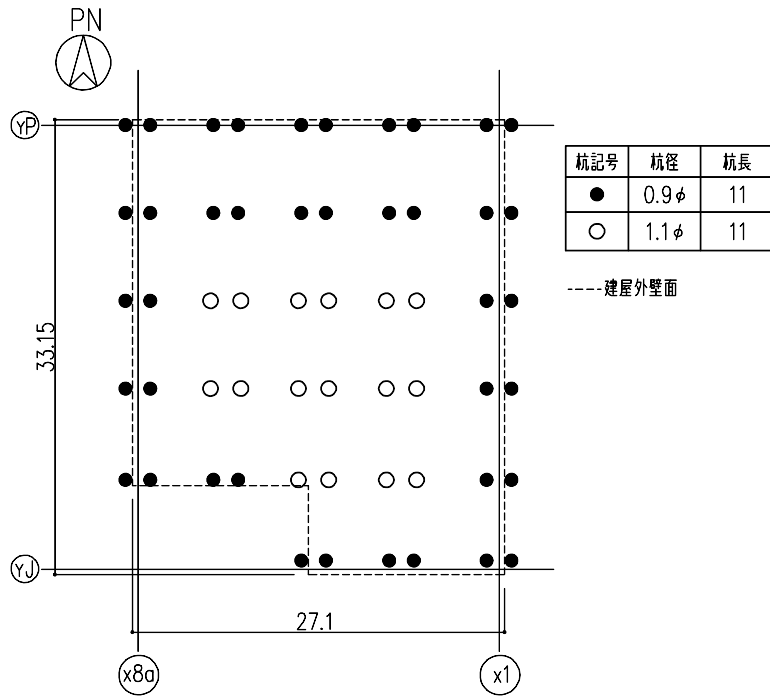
杭配置図 (G.L. -11.0) (単位 : m)
